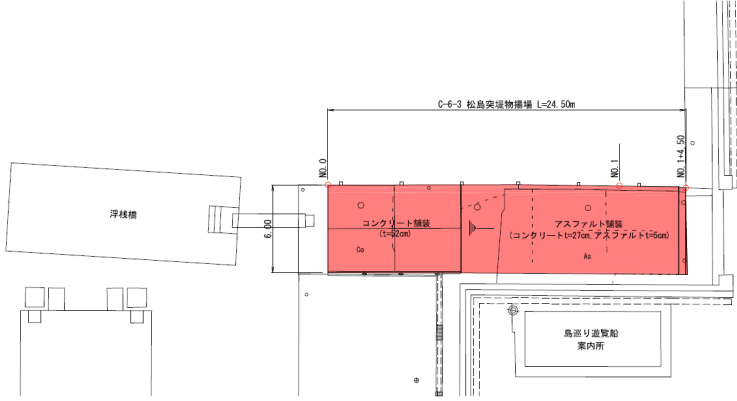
38 No.8 松島突堤物揚場の平面図（被災後）
